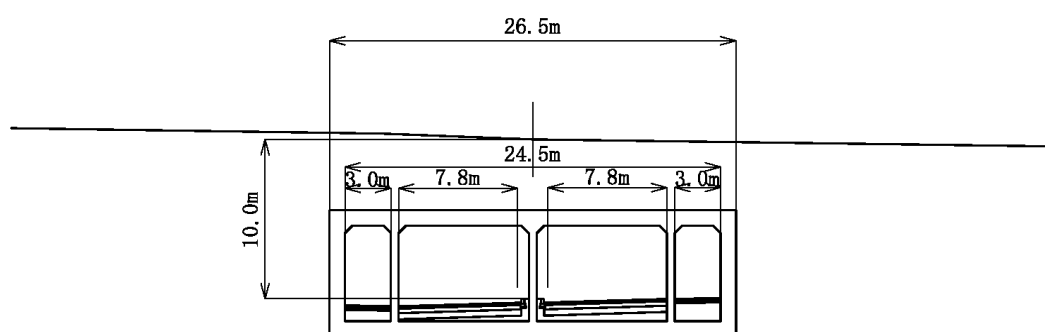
(2) 予測断面図(No.2 宮田村中越)
